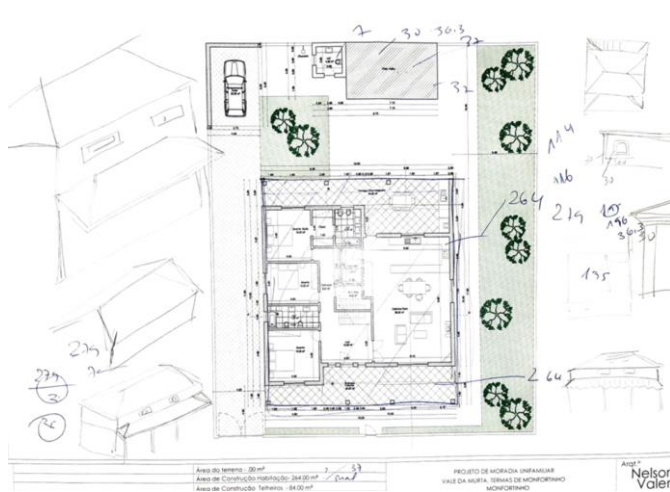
Anotações na planta de R/C. Fonte: Autora
